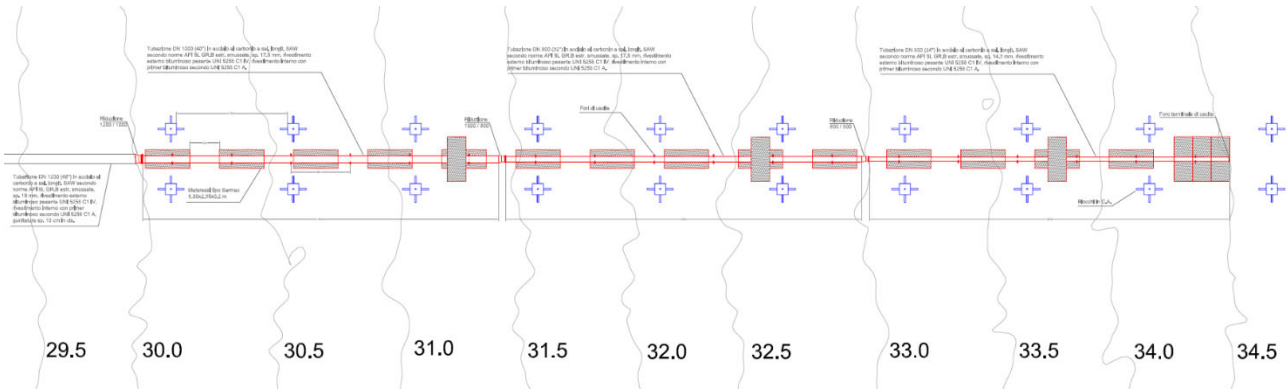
Planimetria diffusore di scarico esistente (Fonte IRETI).
